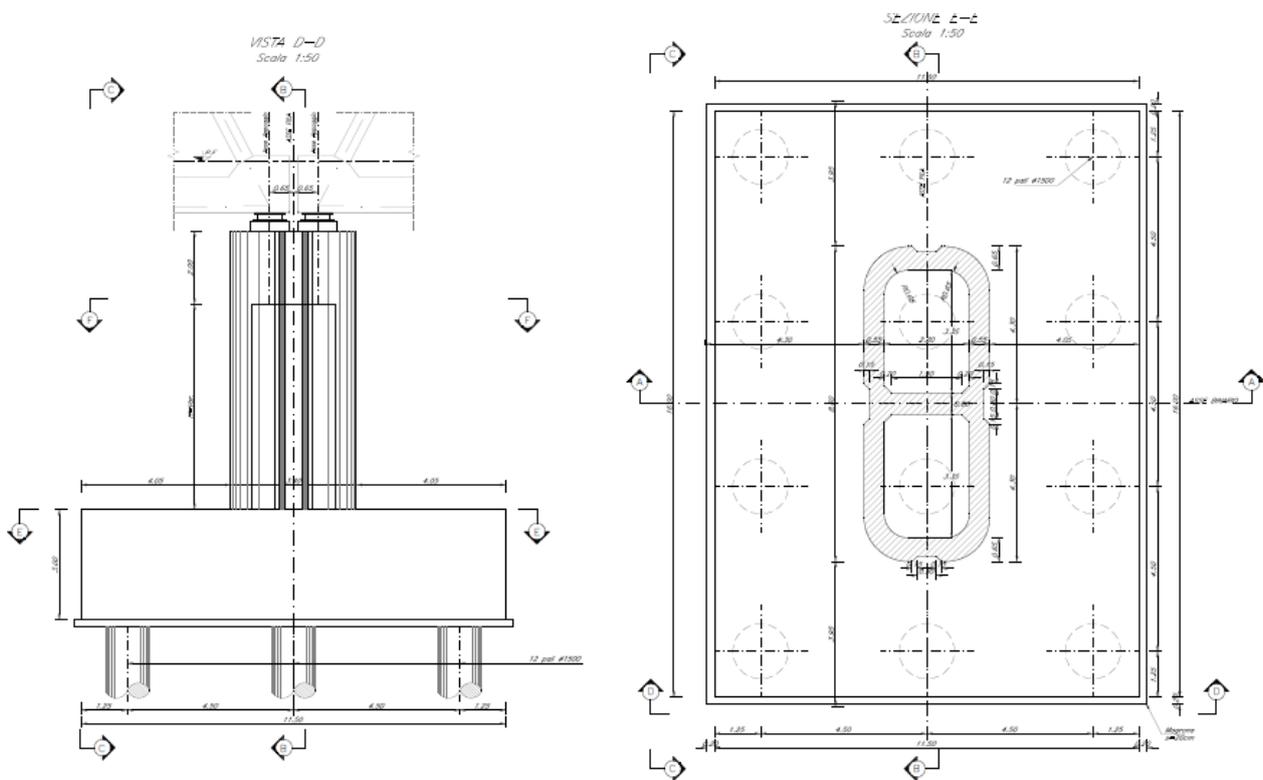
Prospetto e sezione pila campata L=69.70 m
